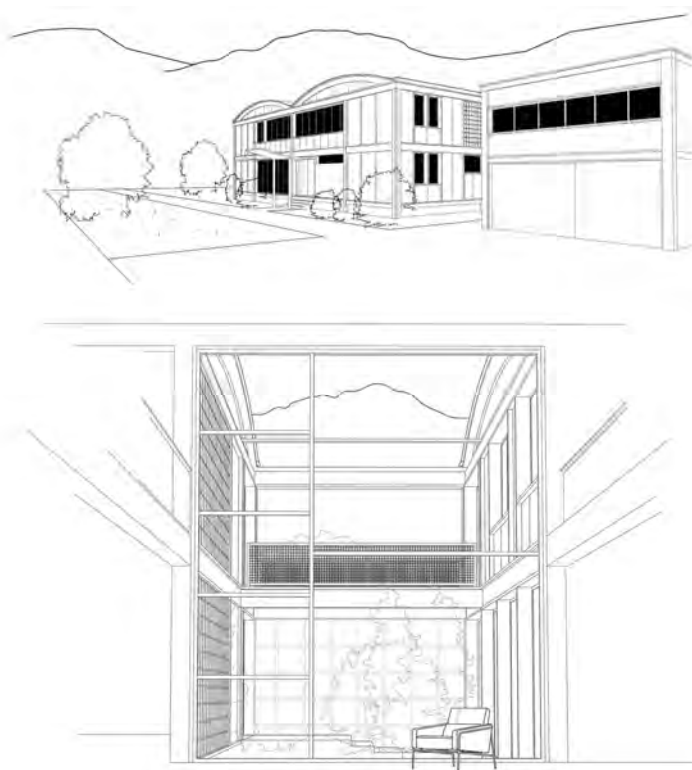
Casa Shaio, relazione formale e visuale tra l'edificio e il paesaggio: il profilo della copertura richiama quello delle montagne poste alle spalle, il patio cattura la vista de *los cerros* in direzione est. Fonte: elaborazione dell'autrice.
